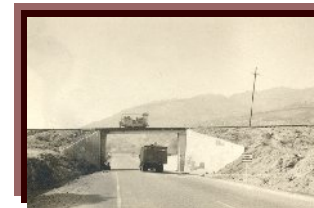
Puente en La Fragua, Zacapa, sobre la Carretera Centroamericana No. 10. Fuente: Carlos Torres.
